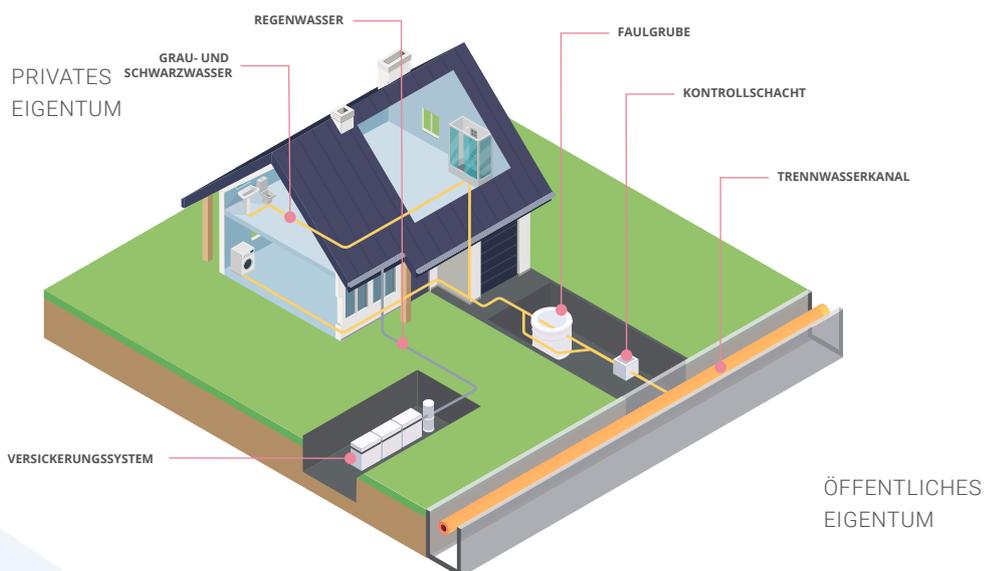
Plan eines Anschlusses eines Wohngebäudes an einen Trennwasserkanal (mit Versickerungssystem)
